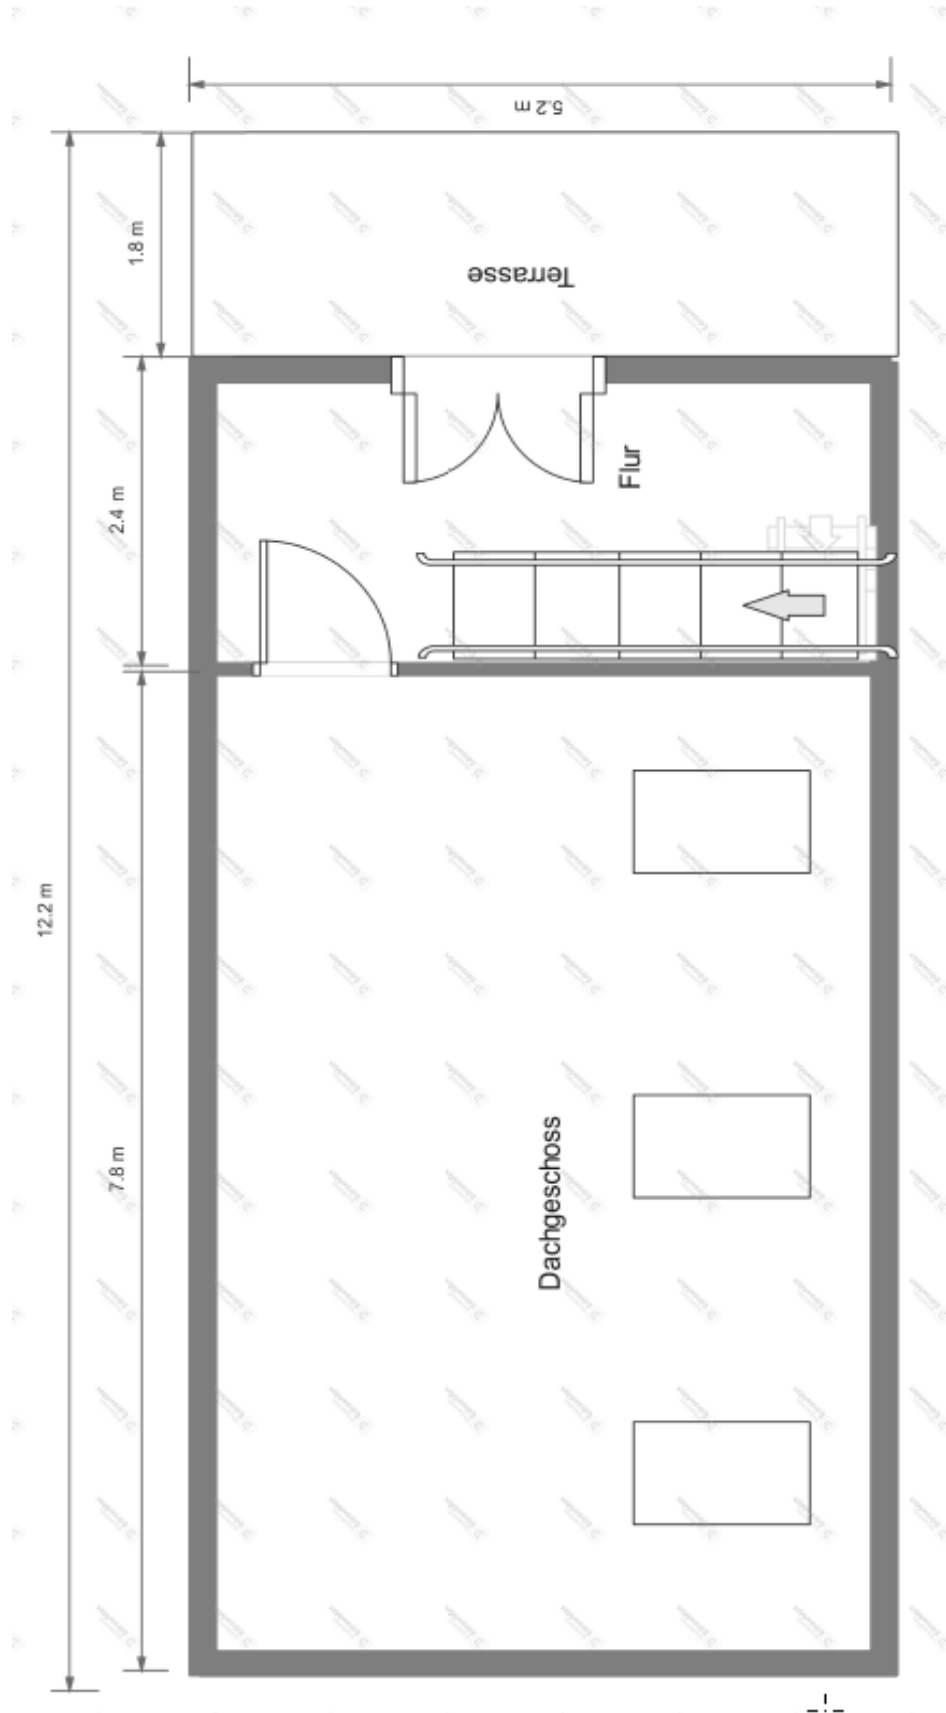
Grundriss DG, nicht maßstabsgetreu, Maße ohne Gewähr
